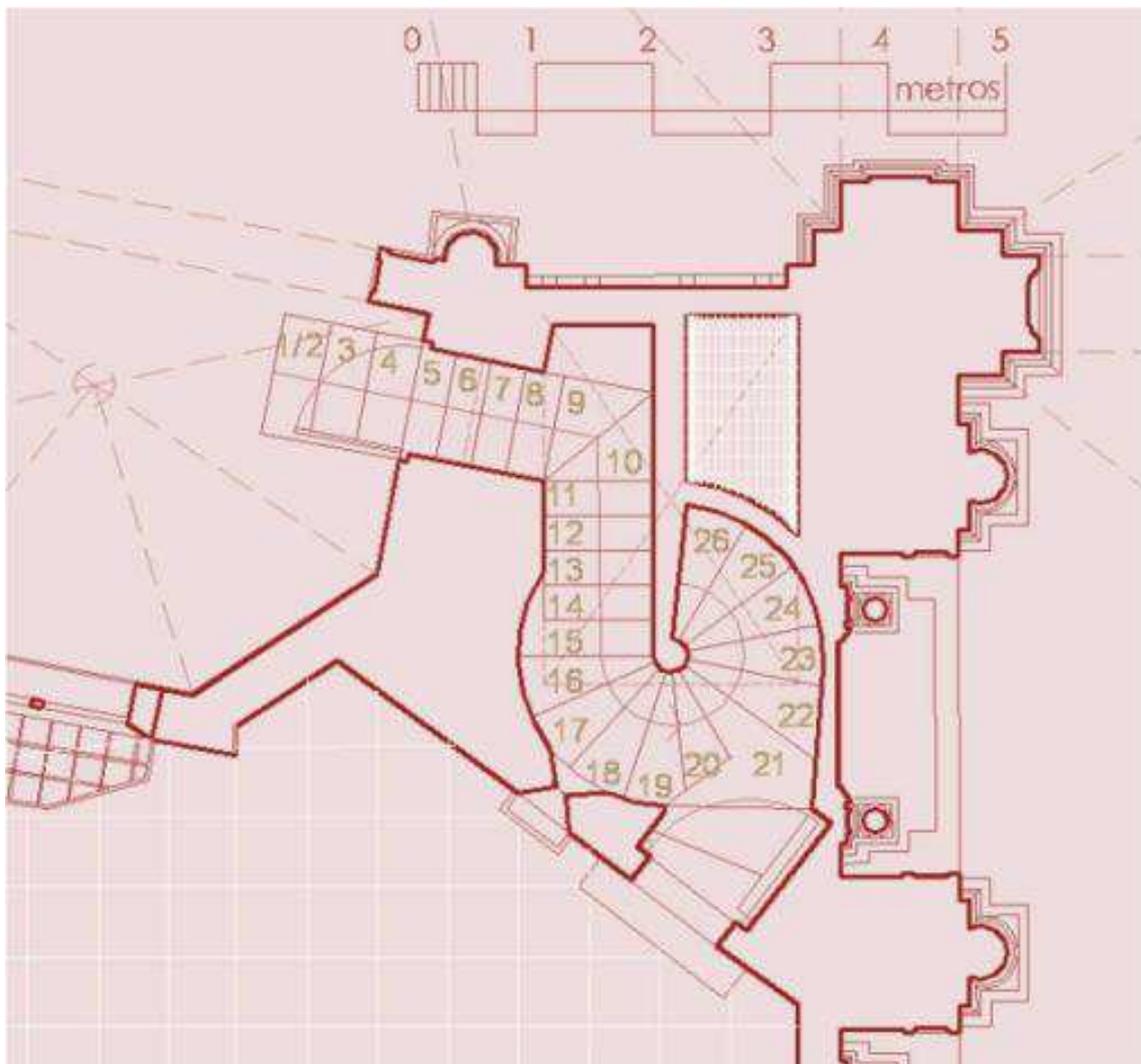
15.9 Estado actual del acceso a la escalera y a la primera planta de las galerías.
